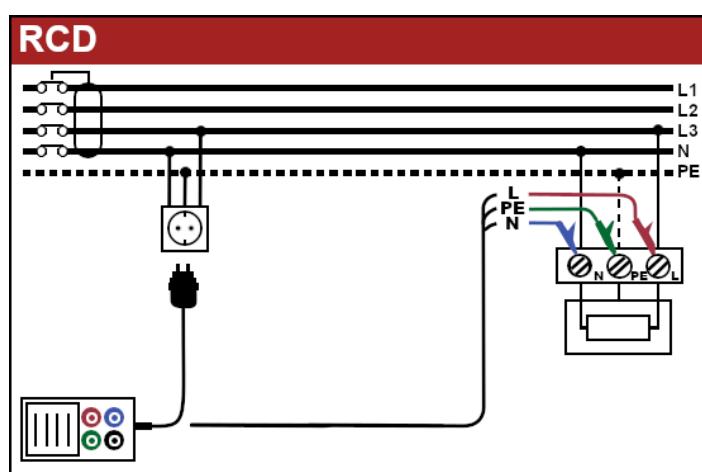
Ansluta pluggtestkabeln eller universaltestkabeln
